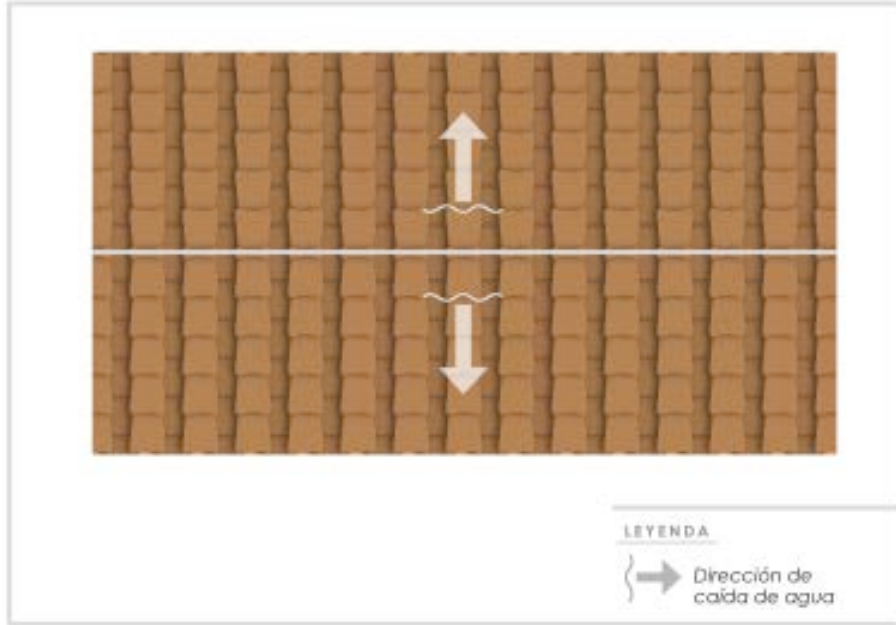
Tipo 2. Esquema de planta rectangular. Techo a dos aguas.
